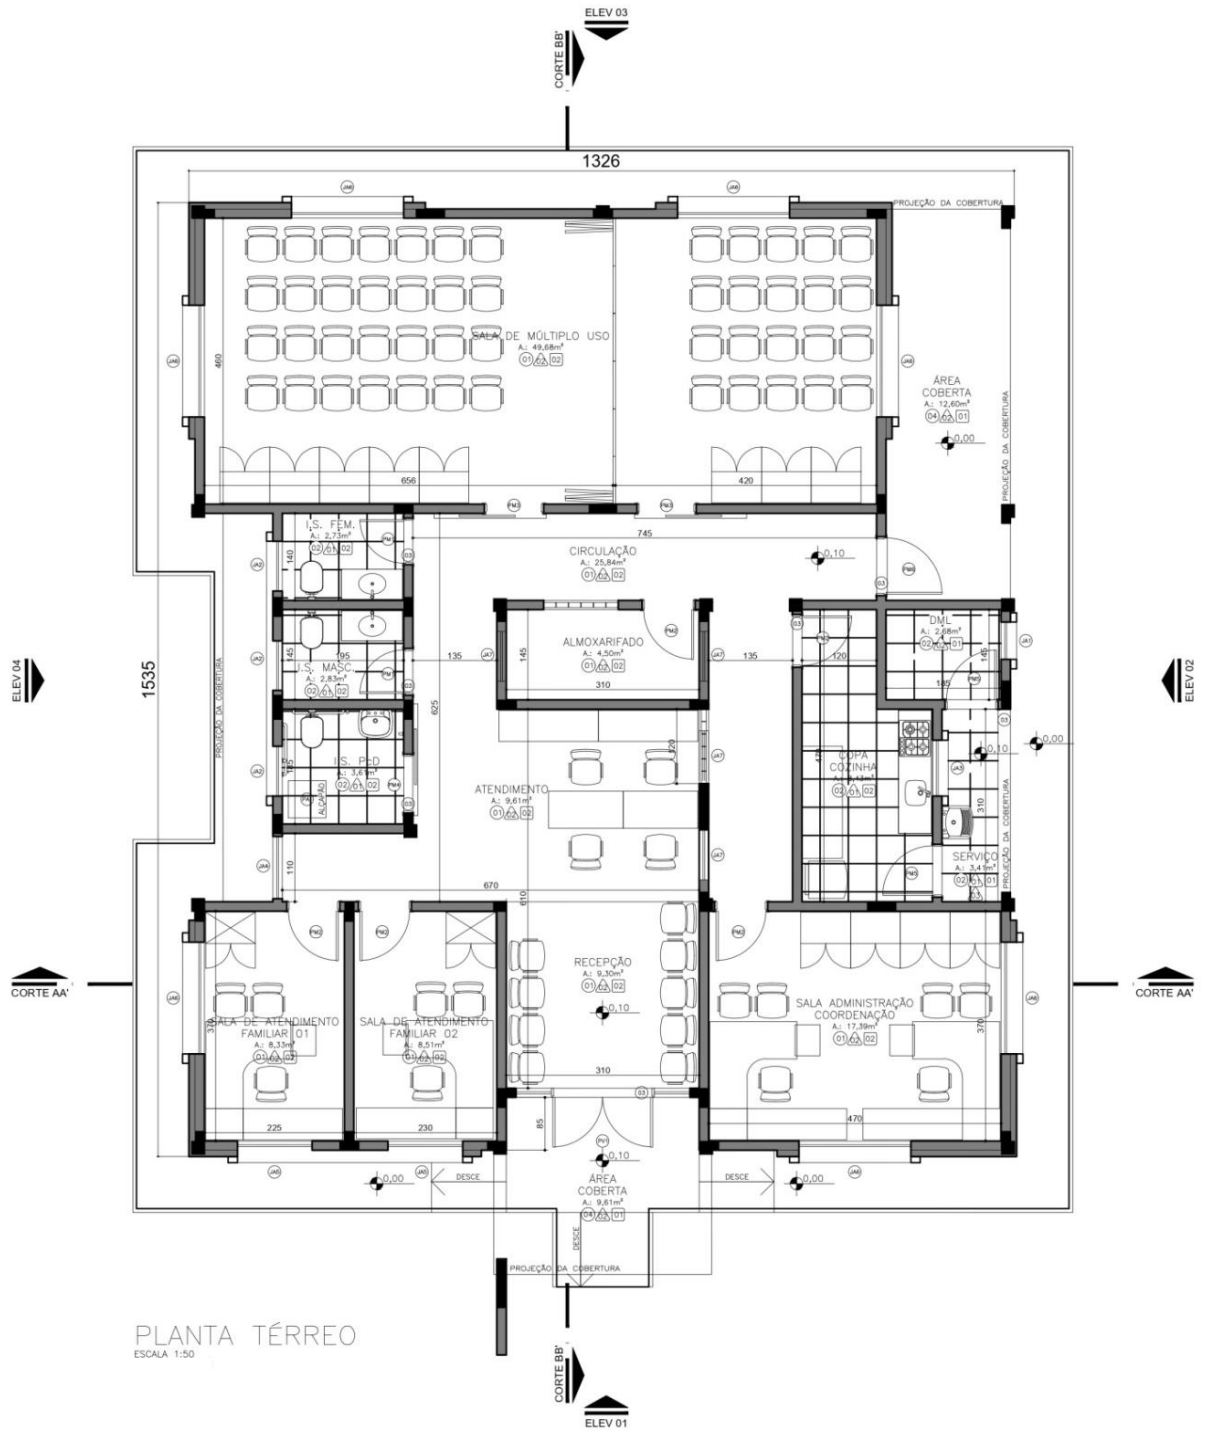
Planta Técnica – CRAS / CREAS – Projeto-Padrão
